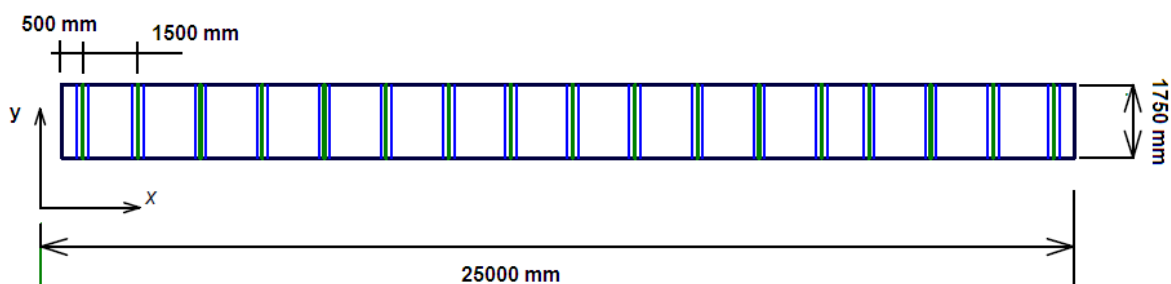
Disposição dos enrijecedores verticais definidos para viga de aço esbelta.
